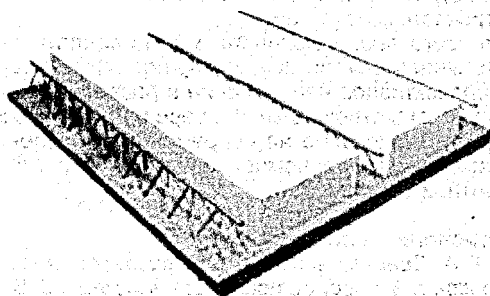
Система перекрытий с применением сборной жб плиты в качестве несъемной опалубки
